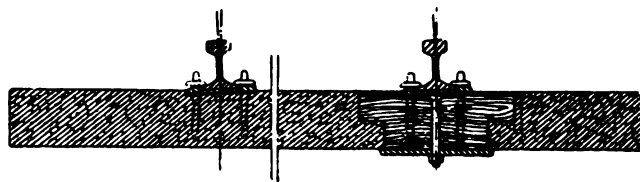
Traverse Thiollier-Bigazzi. - Sezione.
